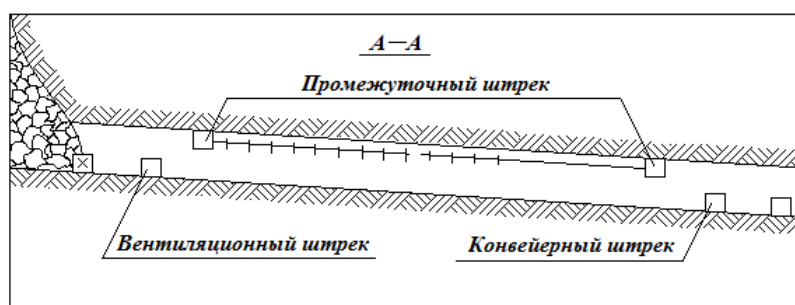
Схема подготовки массива подкровельной толщи к выпуску (поперечный разрез выемочного столба)
